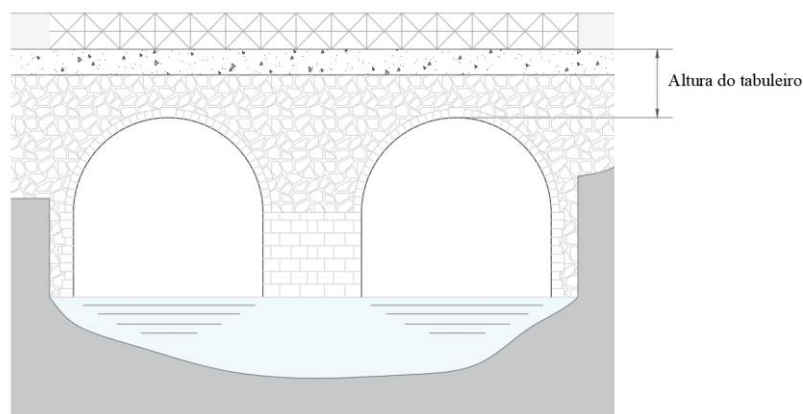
Obra de arte com tabuleiro misto de alvenaria de pedra – betão
